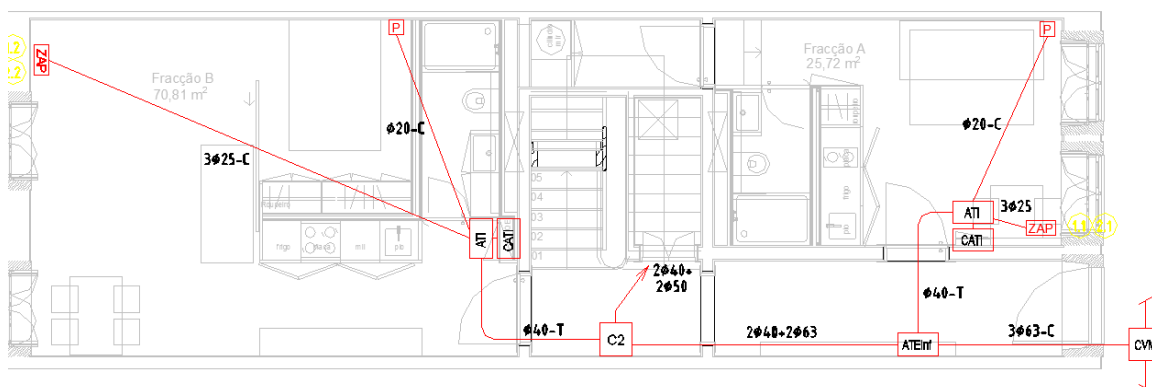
Projeto da rede de infraestruturas de telecomunicações, piso 0, sem escala [Fonte: Plano Inclinado, Lda., 2014].
